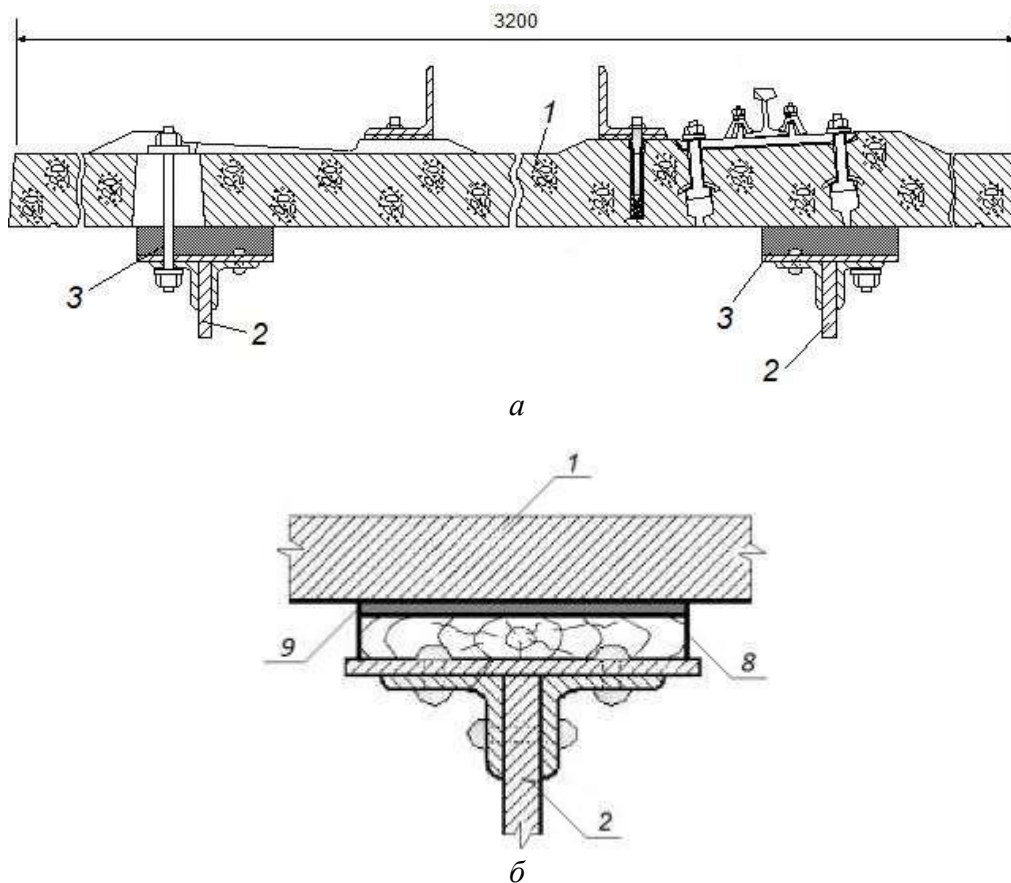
Безбаластне мостове полотно на залізобетонних плитах:
